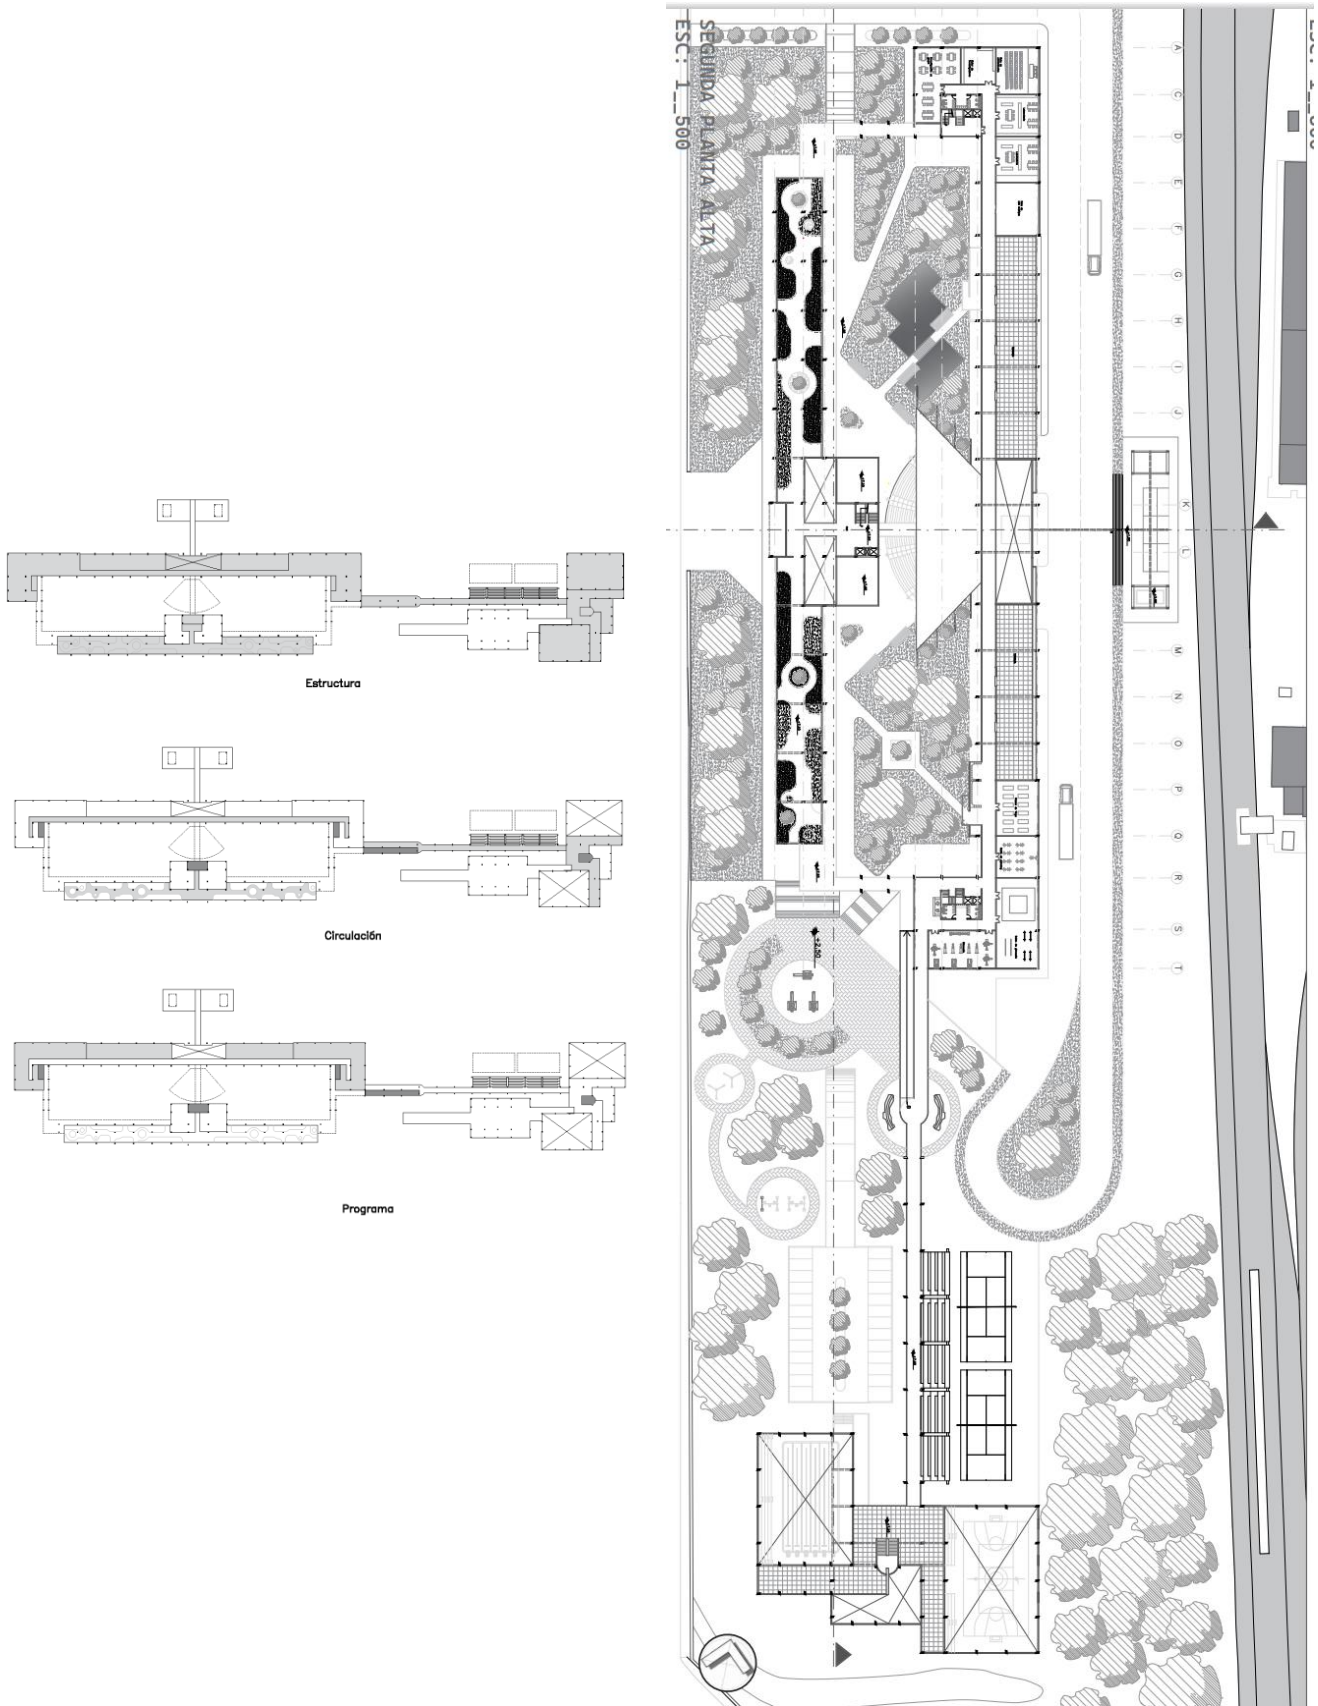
Segunda planta alta N+7.20. Elaboración propia
